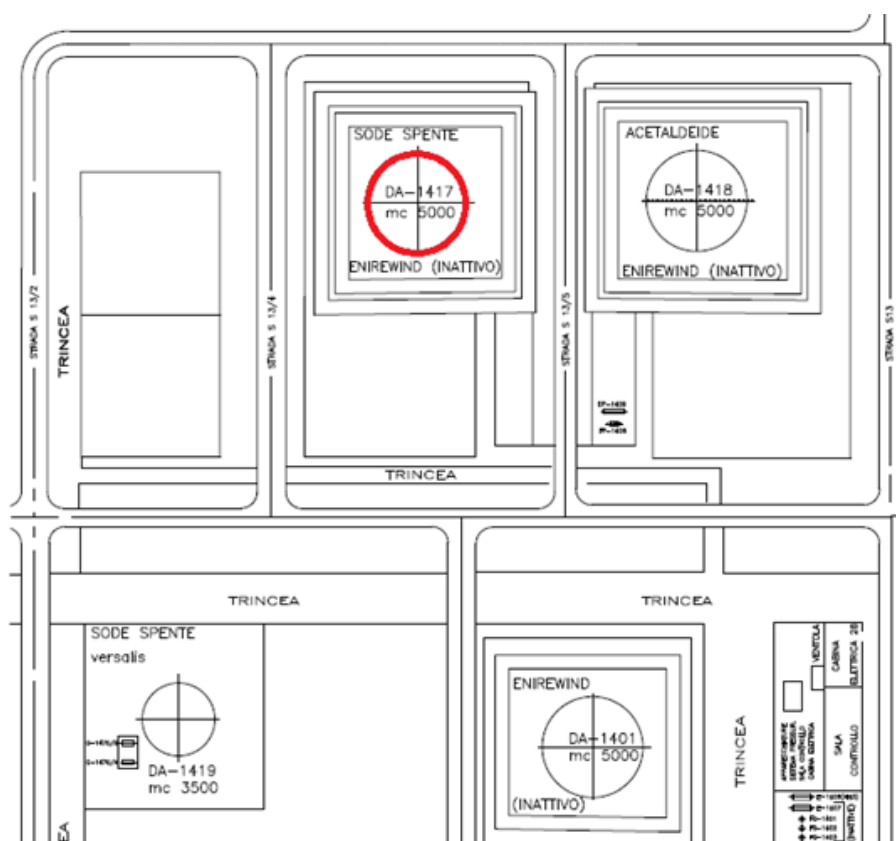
Stralcio planimetrico del serbatoio DA-1417 in area SG11
